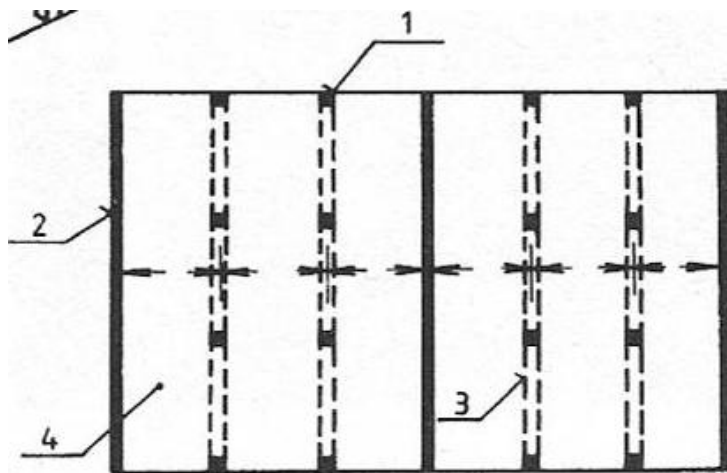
Sloupový konstrukční systém s deskovými, lokálně podepřenými stropy, 1 - sloup, 2 - stropní konstrukce
